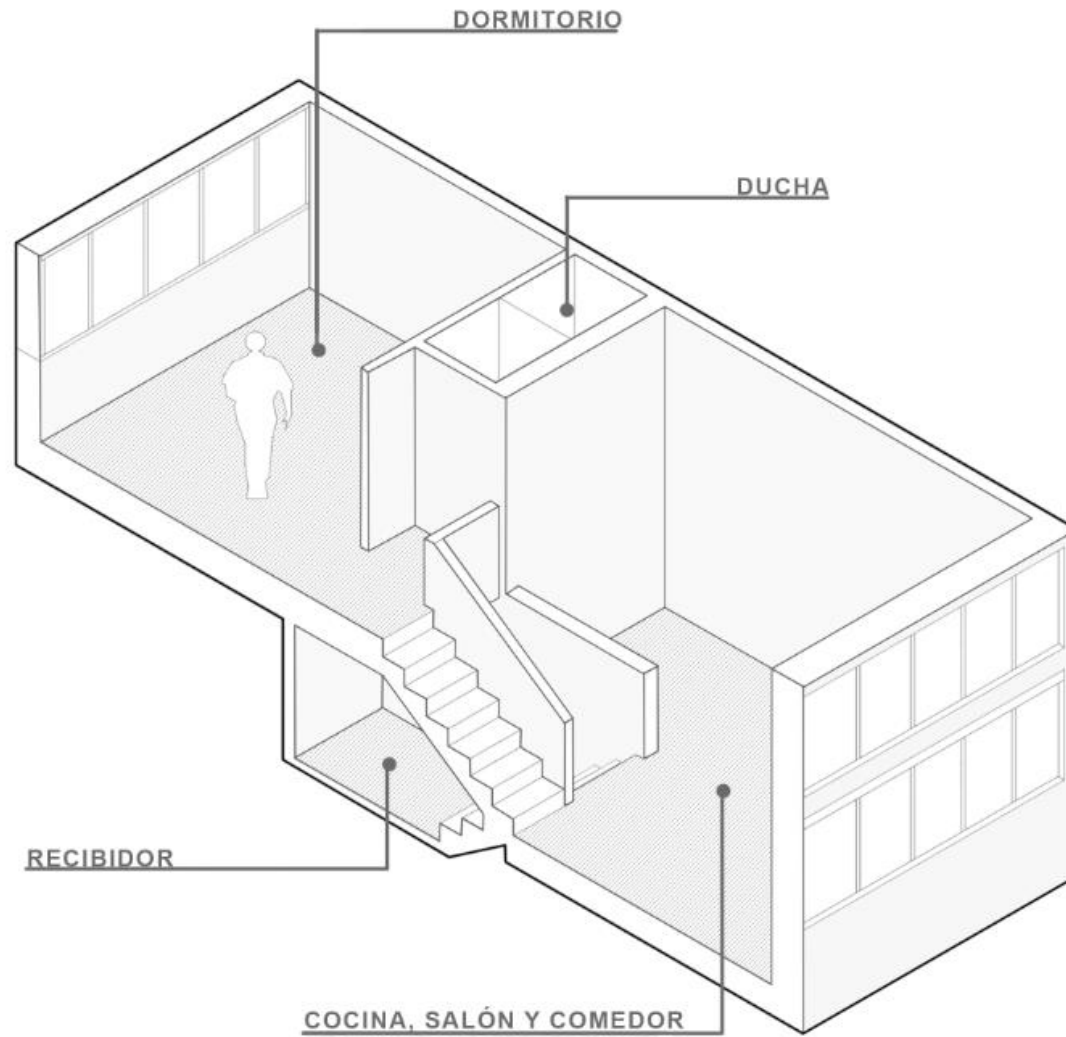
Axonometría de la tipología F. Fuente: Elaboración propia
